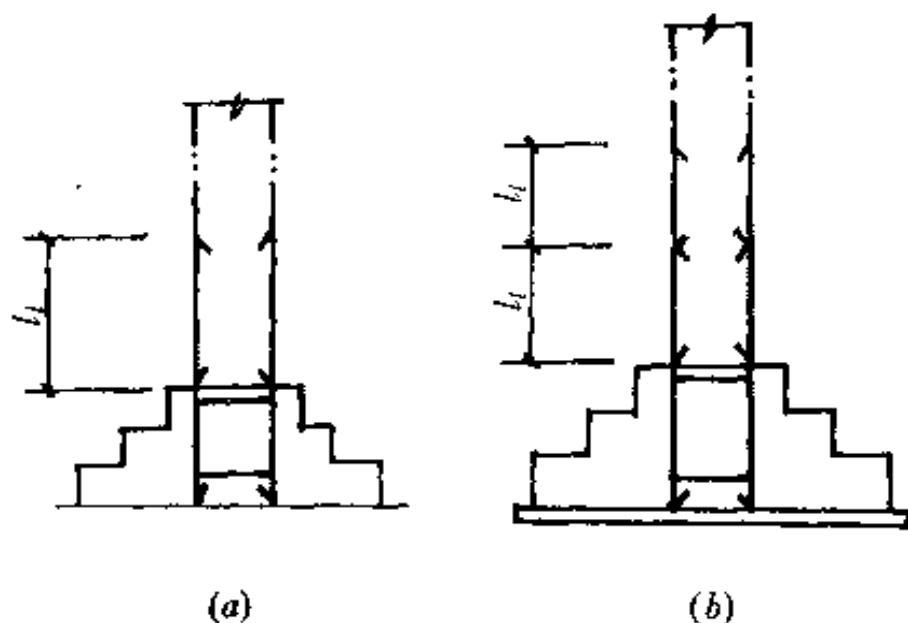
基础中插筋与柱中纵向钢筋搭接位置(3)
